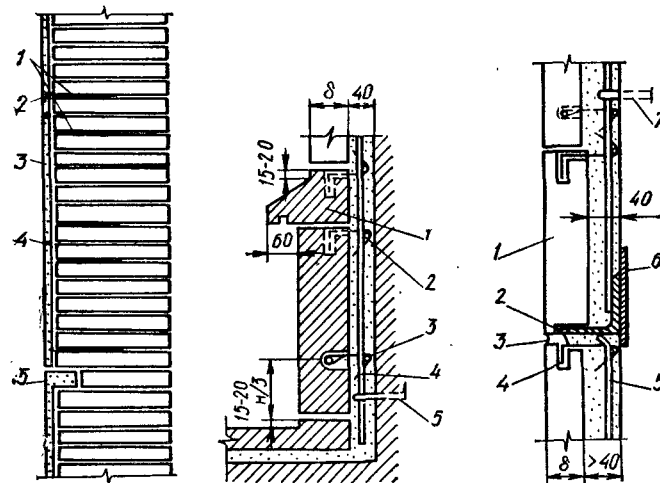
Кладка стен из кирпича или камней с облицовкой фасадными бетонными плитами:
